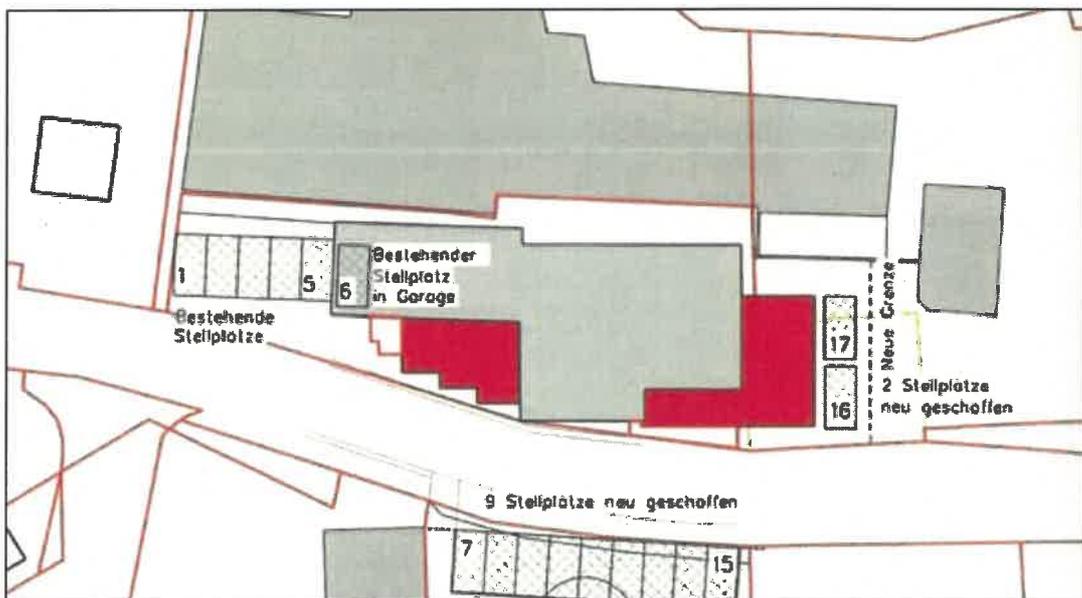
Lageplan mit Darstellung der Anbauten und der Pkw-Stellplätze /52/
